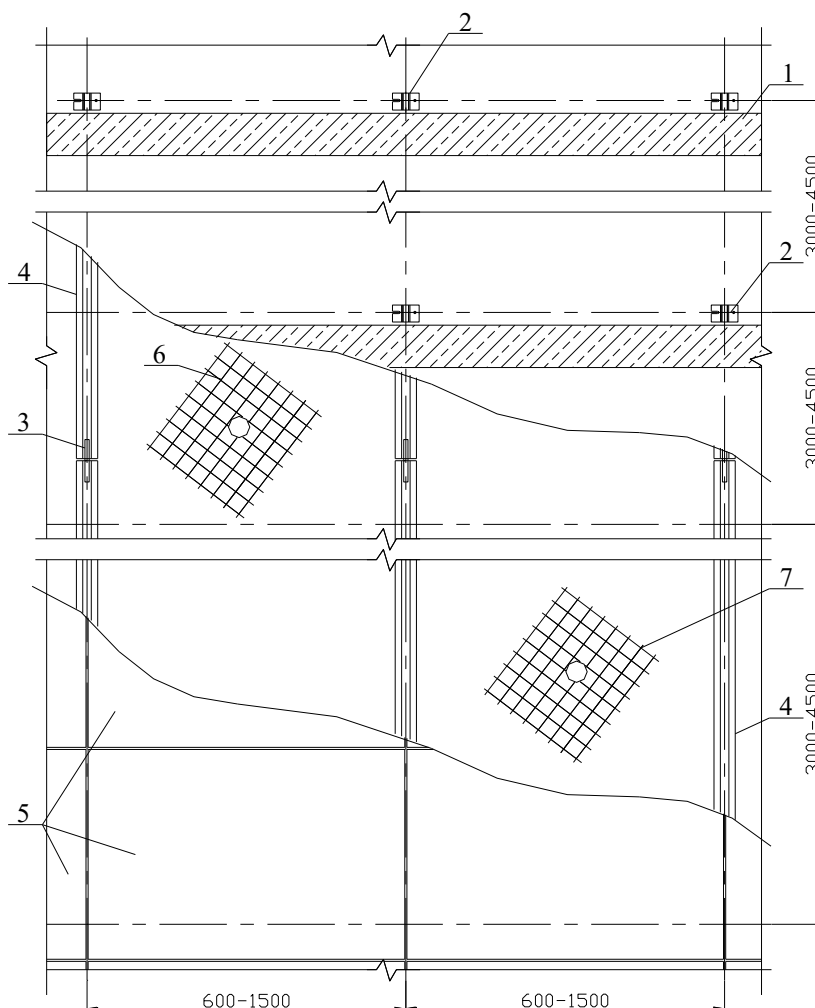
Фрагмент конструктивного рішення фасаду:
